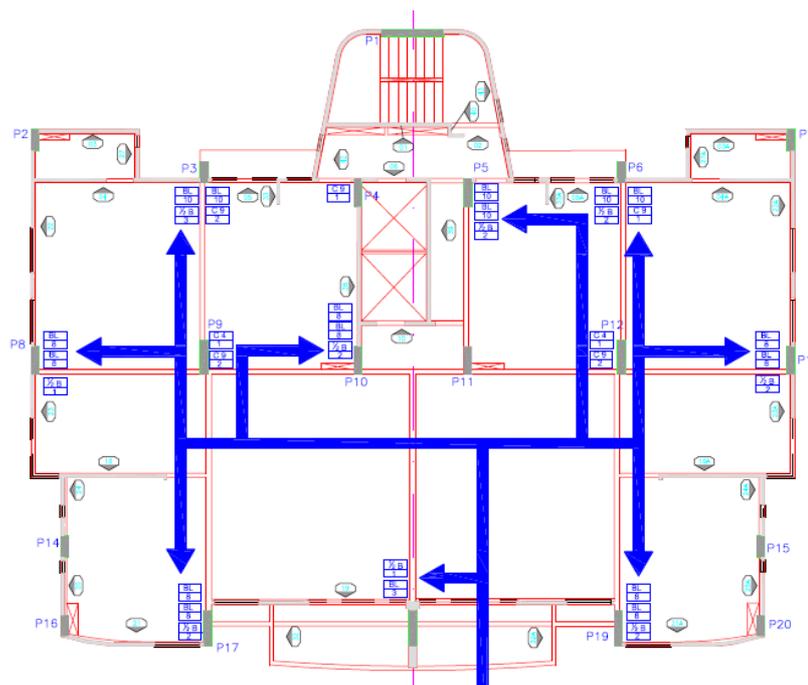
Estudo da distribuição dos materiais no pavimento (PPVVA - obra da empresa “D”)
